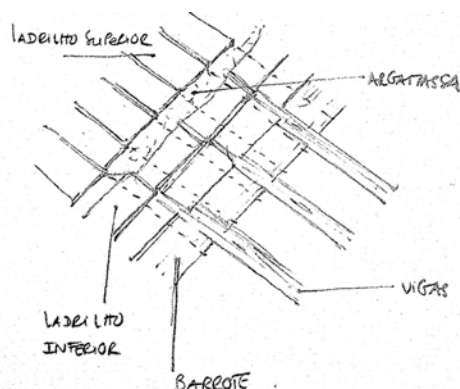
Esquema de sistema construtivo tradicional: mirante algarvio. (Ilustração Nossa, 2017)
